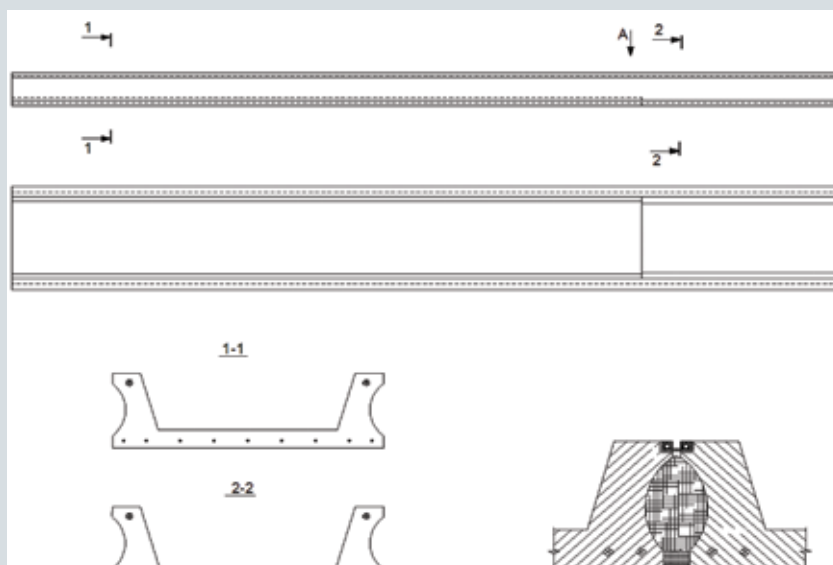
Конструкция сборного блока с высокопрочной напрягаемой арматурой для сборно-монолитной «стены в грунте»
